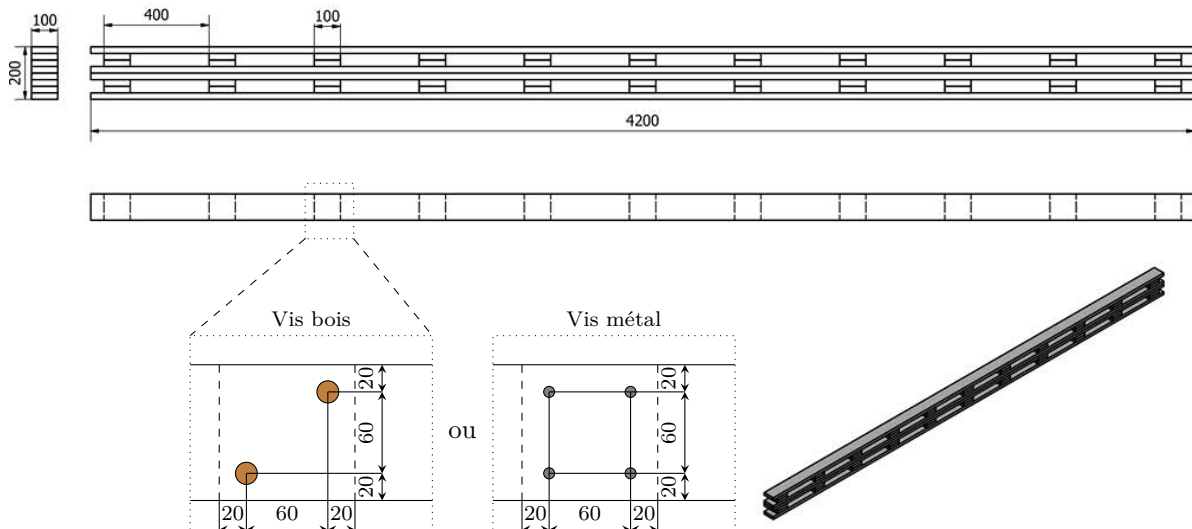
Plan de fabrication des poutres ajourées
